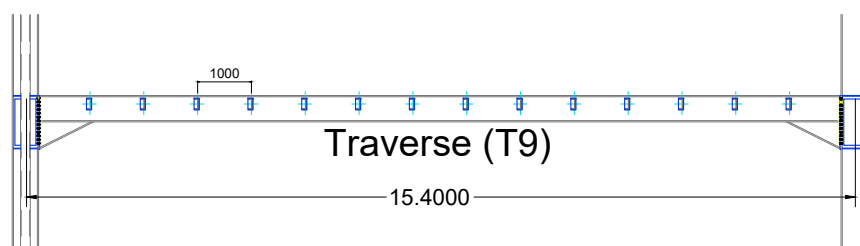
Schéma statique simplifié de la poutre principale
